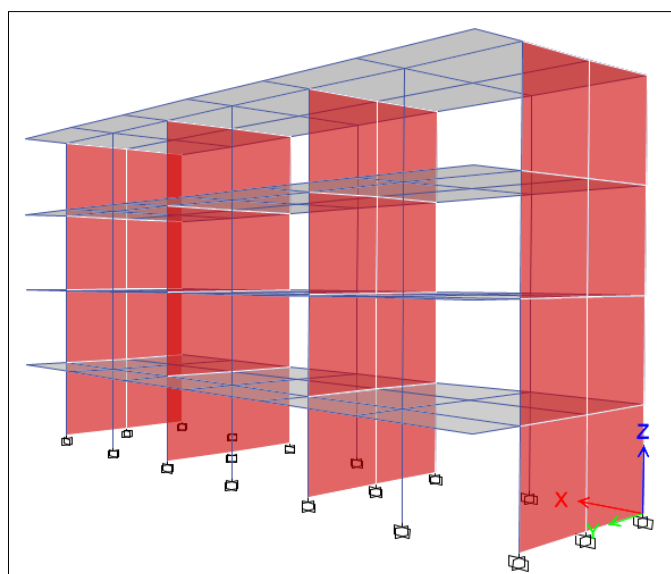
Vista conjunta frontal y lateral del modelo estructural 3D
